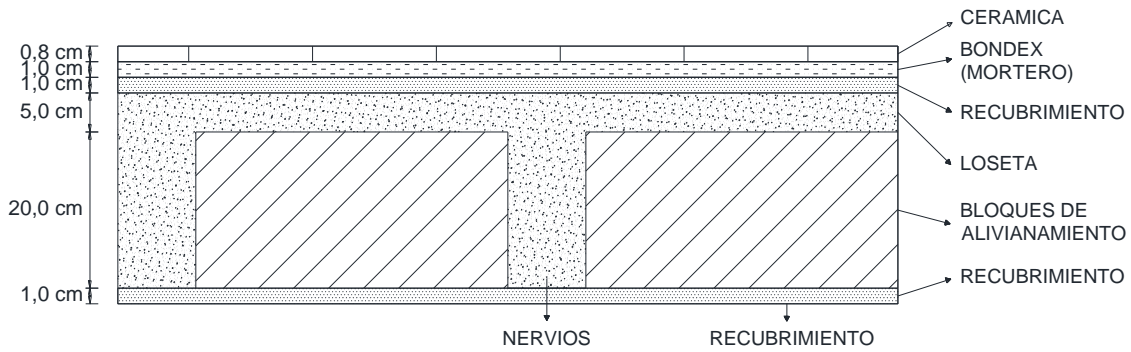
Elevación: Losa Alivianada 25 cm – “Vivienda del Sr. Walter Santos”.
